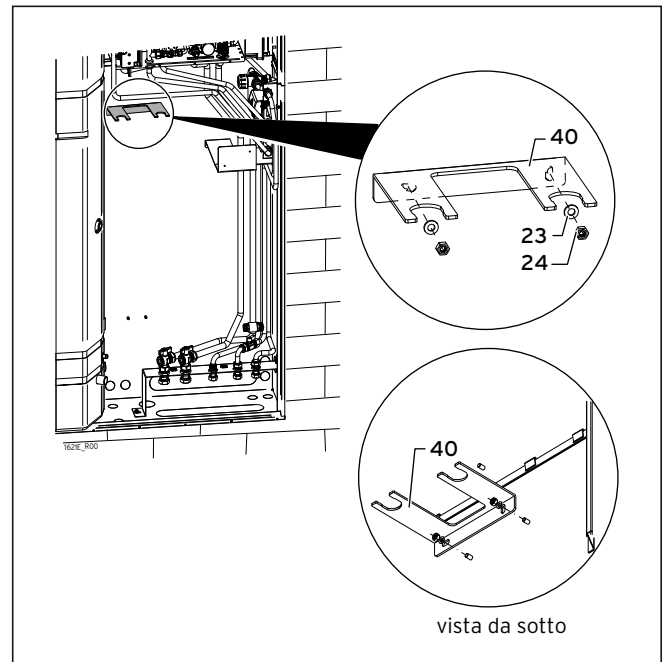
Montaggio staffa di sostegno stazione solare
